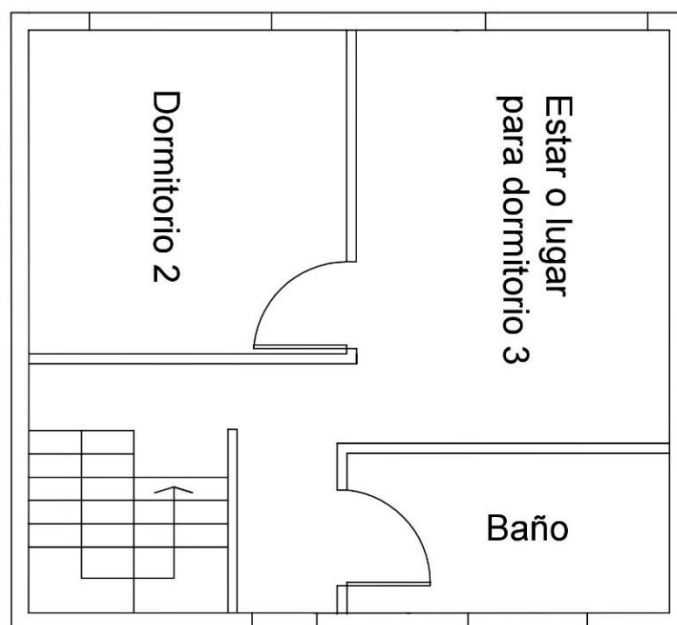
Planta vivienda social mejorada [Elaboración propia].
